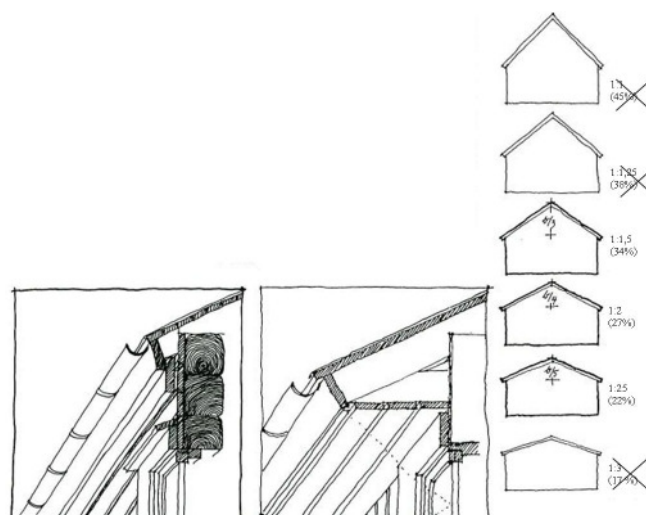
Traditionell takfotslist med vägg ovanför fönstret. Bild 2. Modern inklädd takfot, visuellt hopknyten med fönstren. Bild 3 Olika taklutningar
